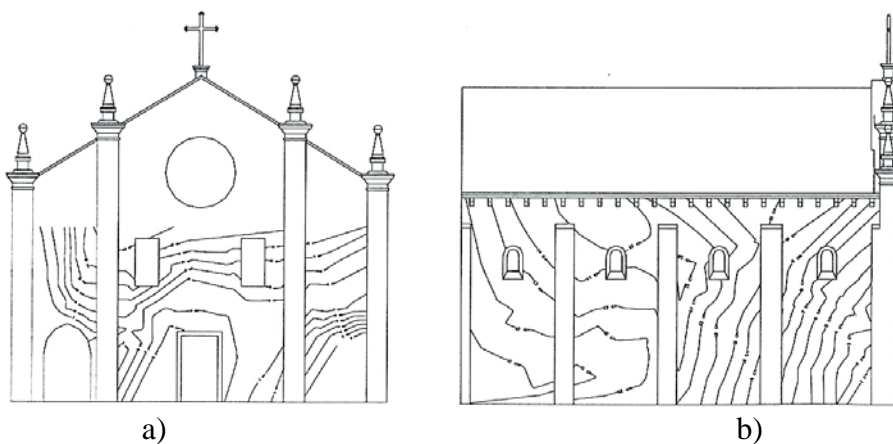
[4k]: a) Levantamento das deformações da fachada principal; b) Levantamento das deformações da fachada lateral esquerda
